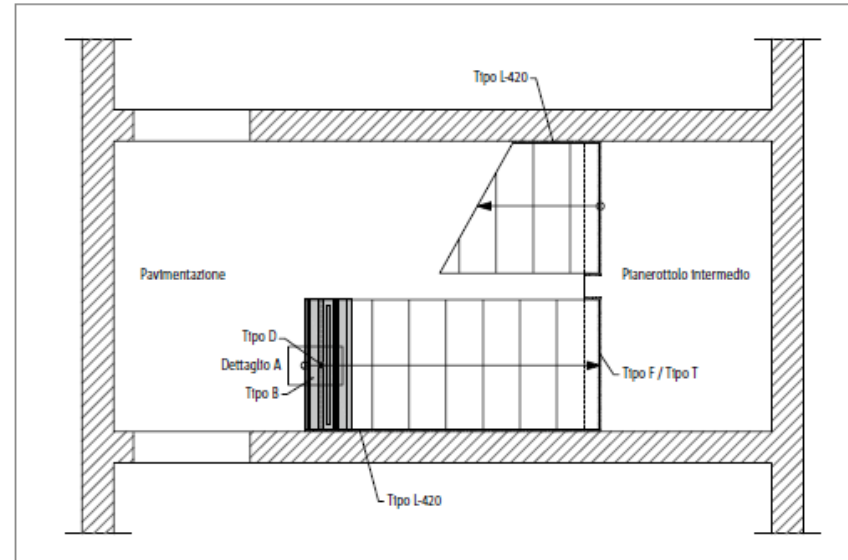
Schöck Tronsole® tipo B + tipo D: disposizione dell'elemento nella pianta
